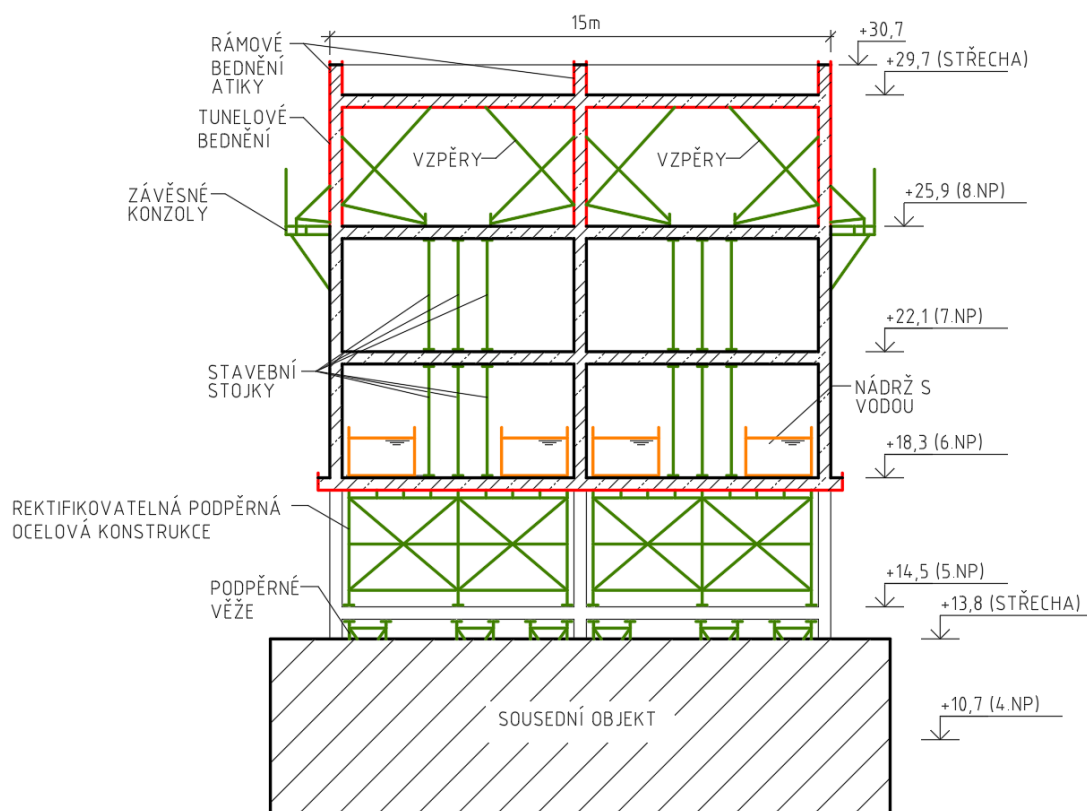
Schéma 2. záběru výstavby vyložené konstrukce
